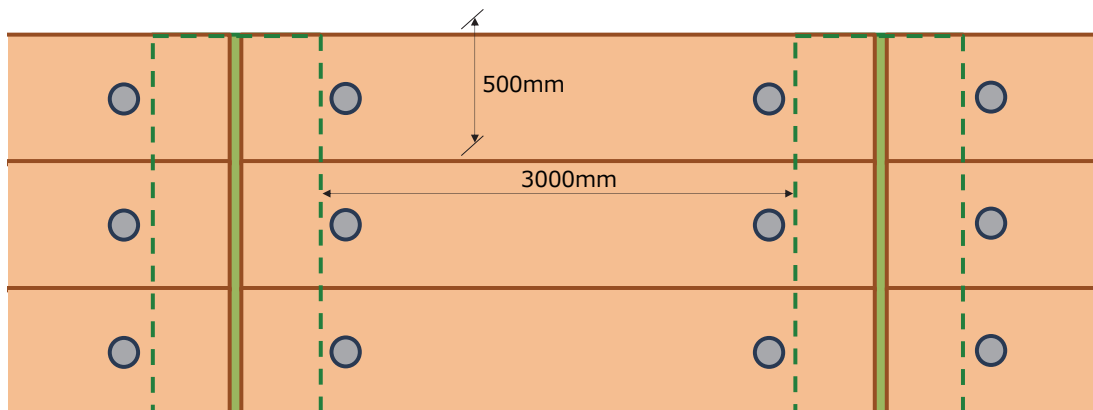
標準的なプラットフォーム CLT 床板の平面図
